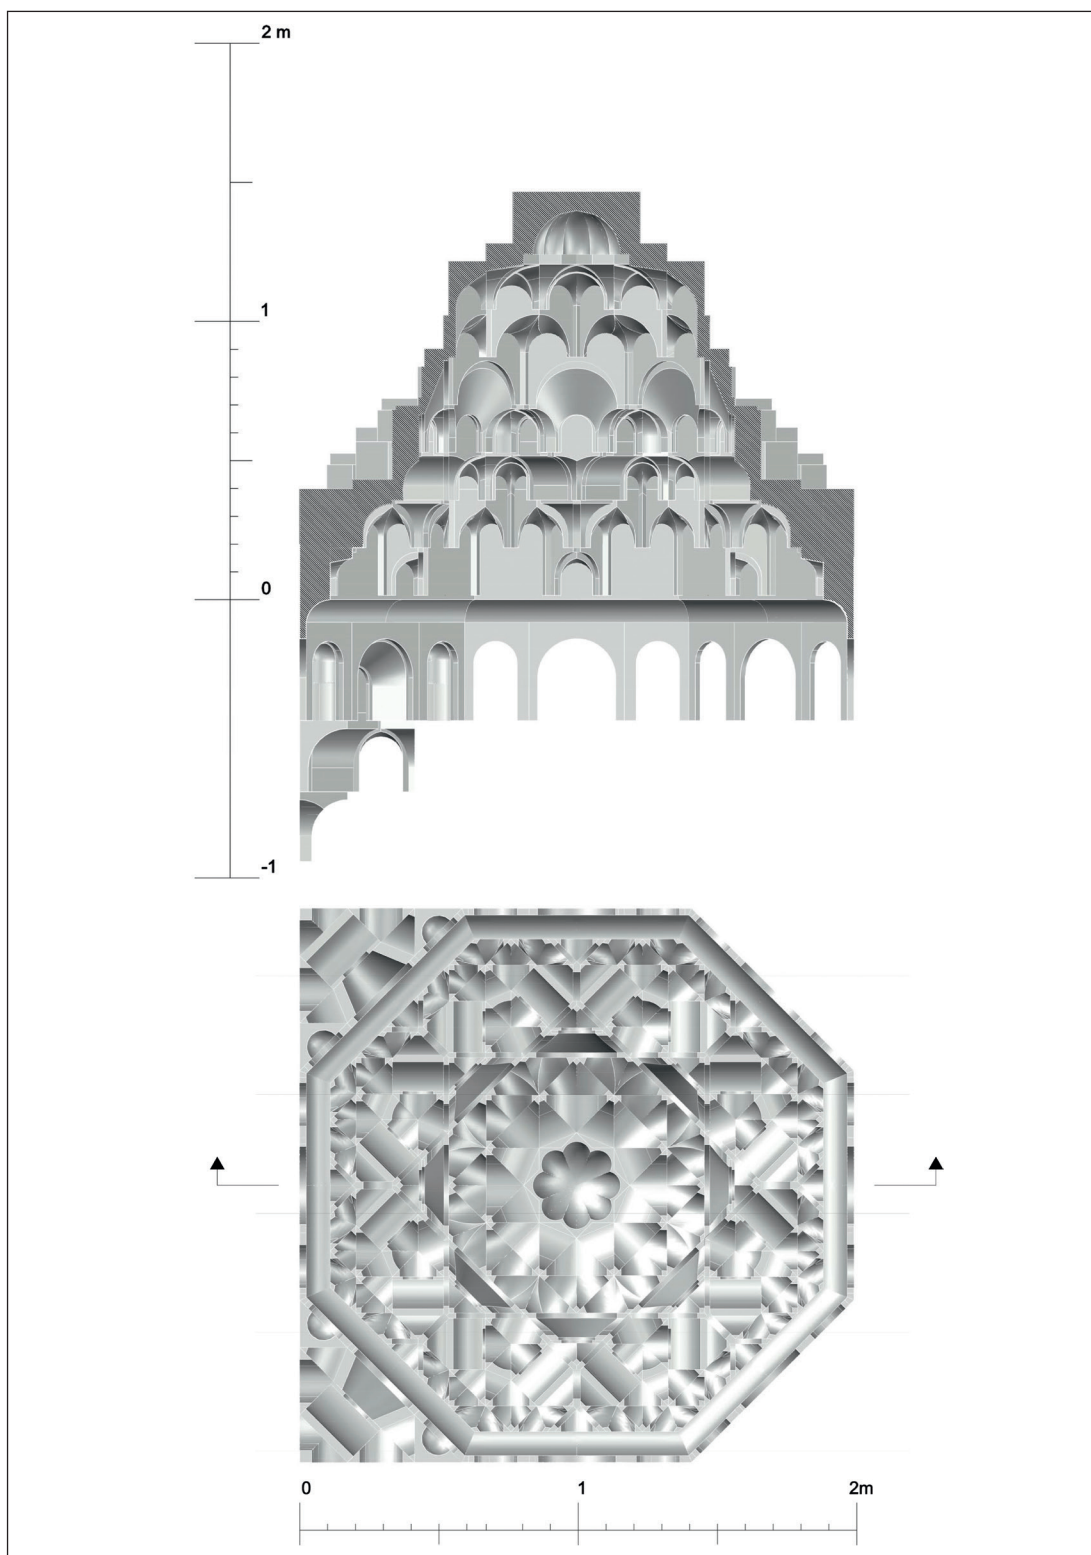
Planta y sección del modelo tridimensional elaborado para la bóveda T4.
